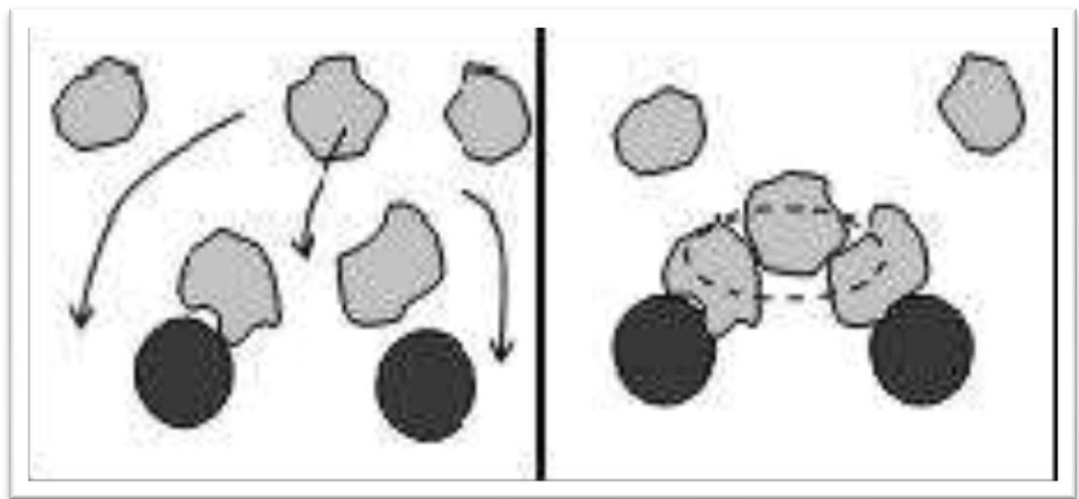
représentation en plan d'un blocage de granulats à travers deux armatures. [17]
